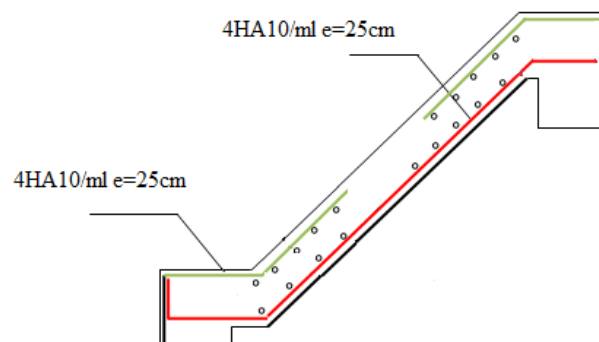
Schéma de ferrailage de la 1^{ère} volée
